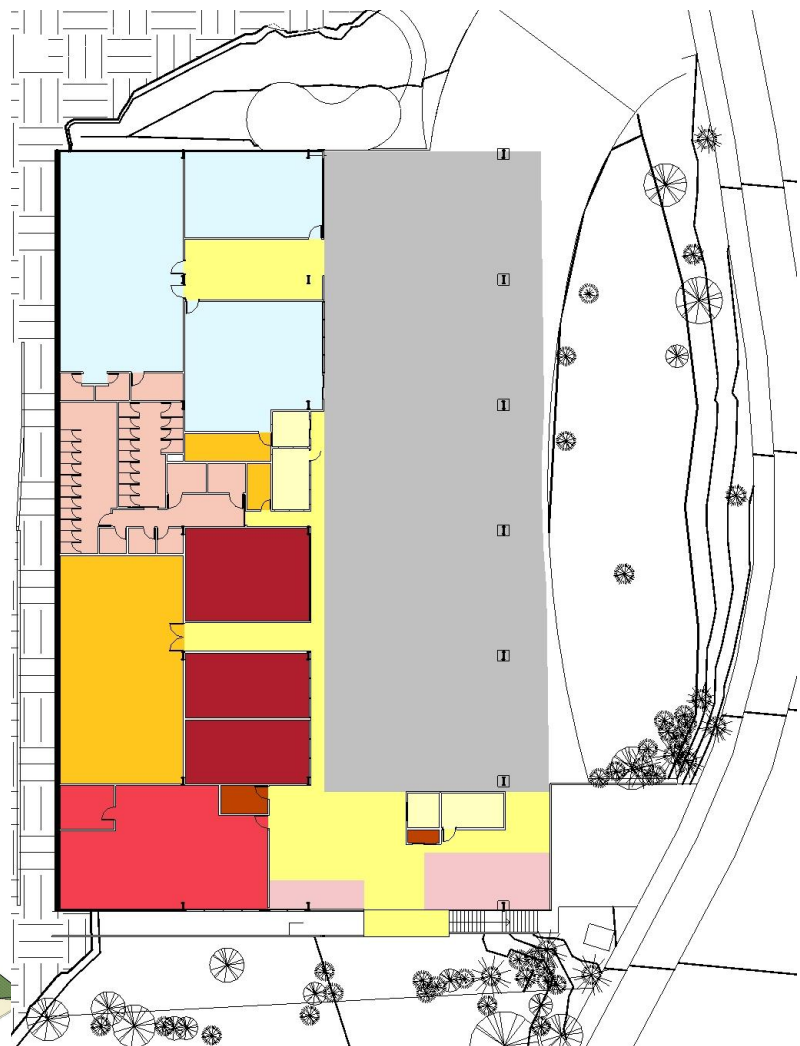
Zonificación, planta nivel 1 Fuente propia.
